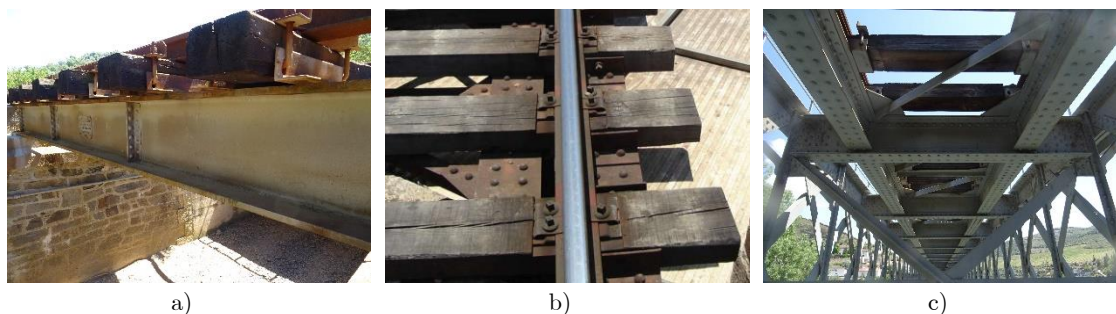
Tabuleiro: a) Viga sob carril, b) Vigas gêmeas e c) Longarina-Carlinga.
